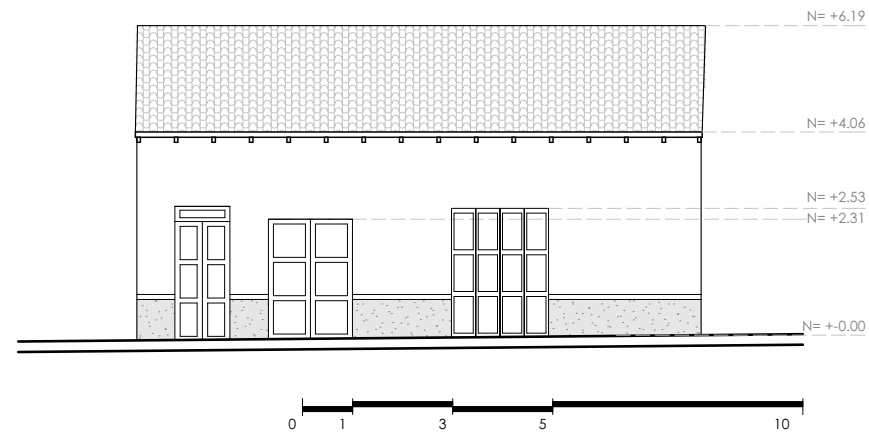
Elevación oeste | Caso de estudio 1, Vivienda Villacis.
